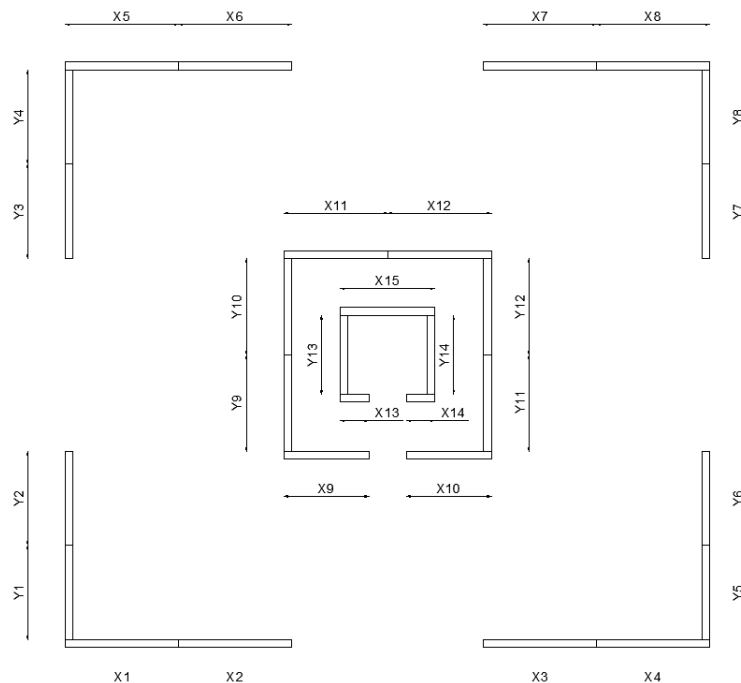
Disposizione in pianta dei setti tipologia B.
